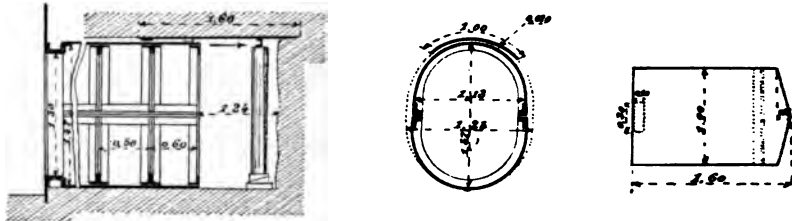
Coupes longitudinale et transversale. — Plan du bouclier.
